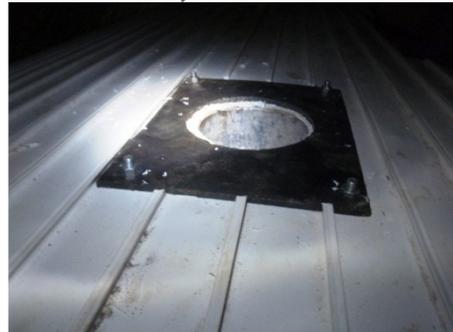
y 142: Placa metálica, utilizada para sujetar T-Lock a Cimbra
